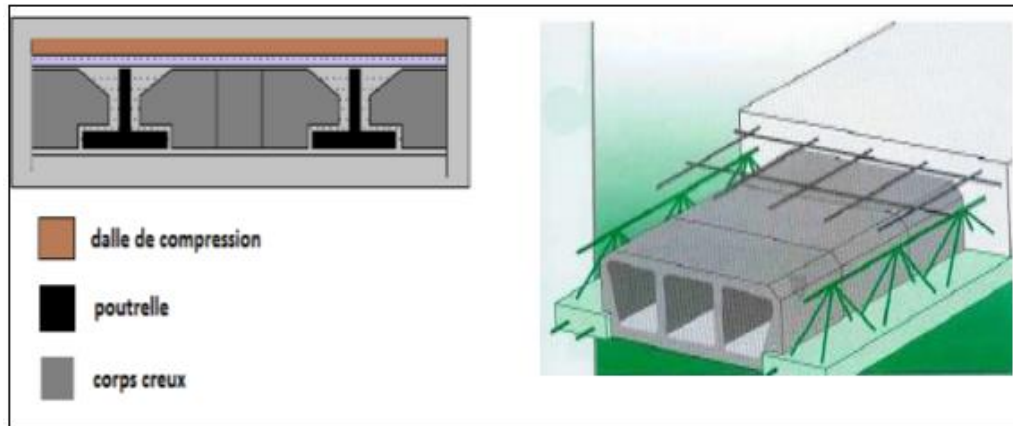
Schéma d'un plancher à corps creux (Internet)
